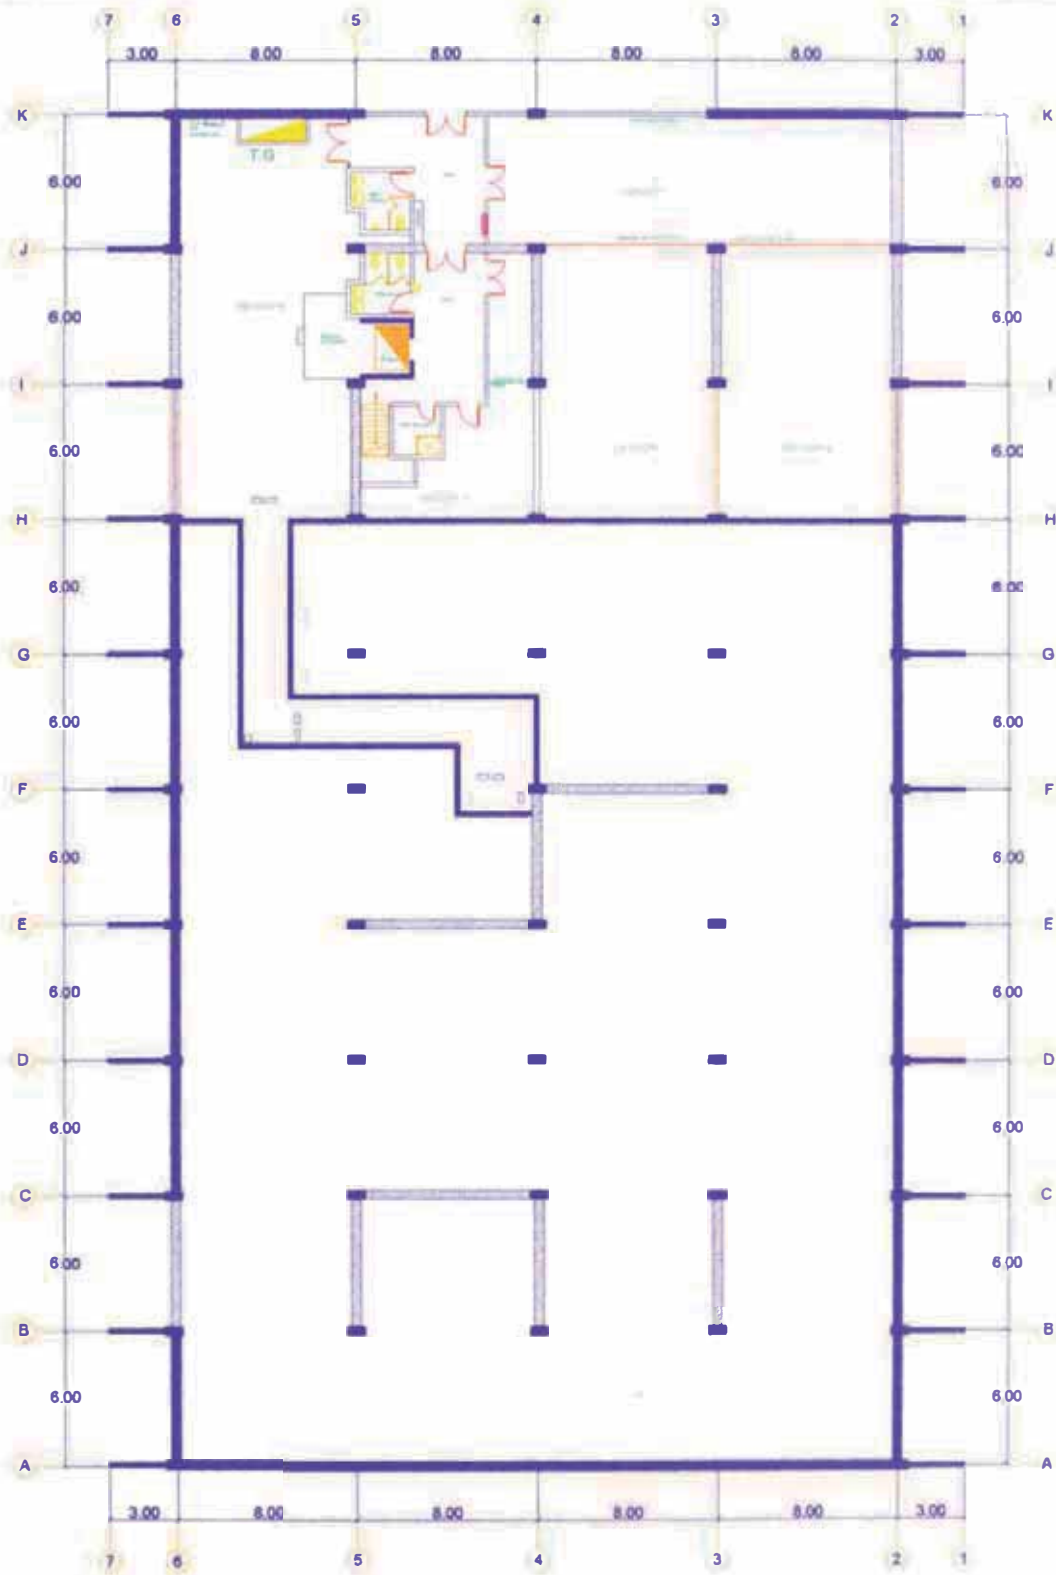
Vista en planta del semisótano (solo la parte superior).
